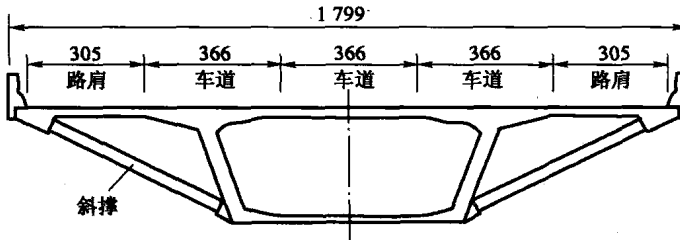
第二阶段的三车道箱梁结构断面示意图(尺寸单位:cm)
